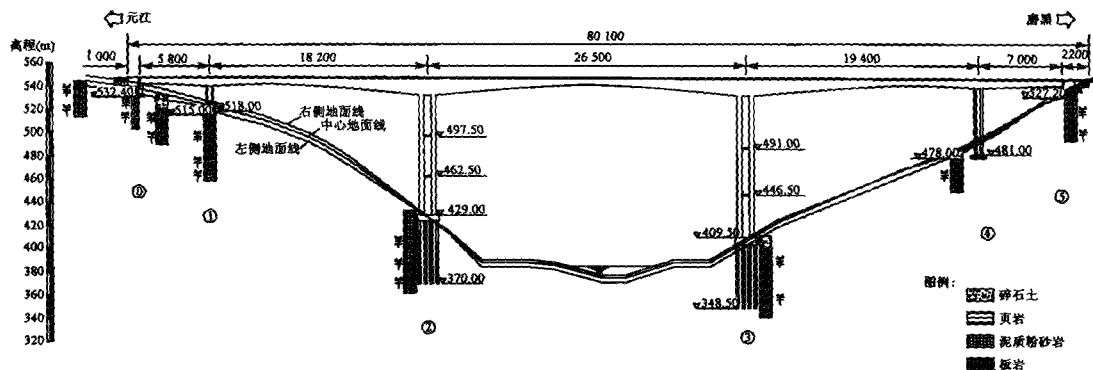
云南红河大桥总体布置图(尺寸单位:cm)
